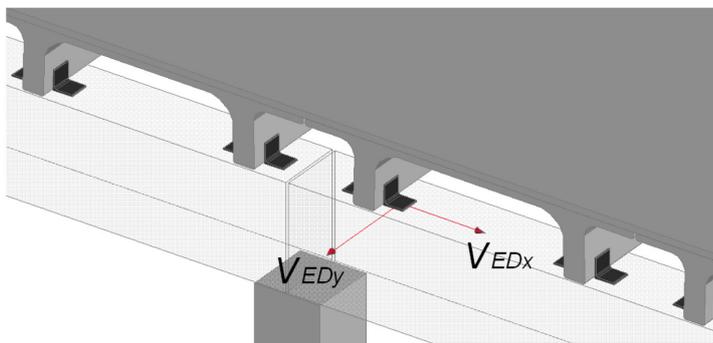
Esempio di collegamento dei tegoli di copertura alle travi portanti (dalla pubblicazione "Linee Guida per la progettazione sismica di strutture prefabbricate"- ASSOBETON Sezione Strutture Prefabbricate – 2011)
